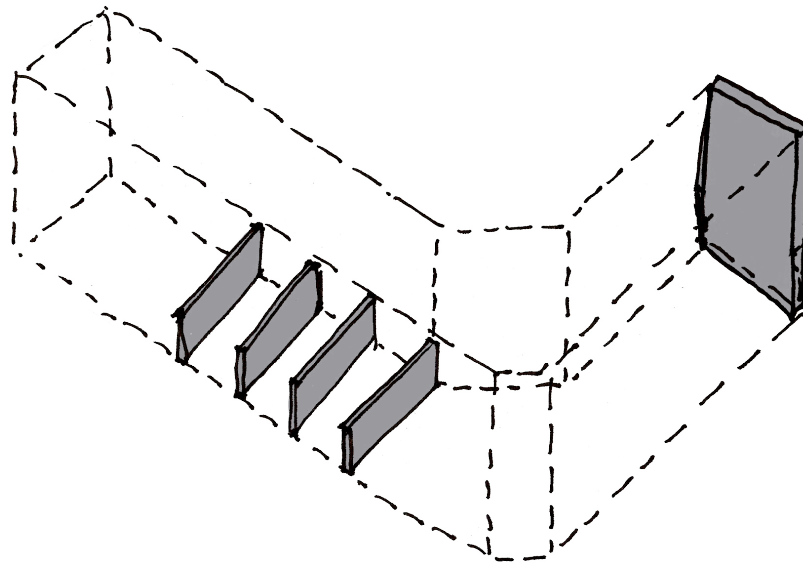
IMAGEN III. Esquema refuerzo en muros del edificio. Fuente: elaboración del autor.
